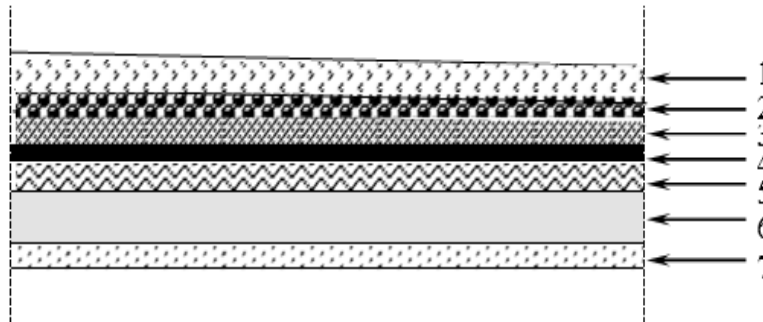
Coupe verticale du plancher terrasse inaccessible.
